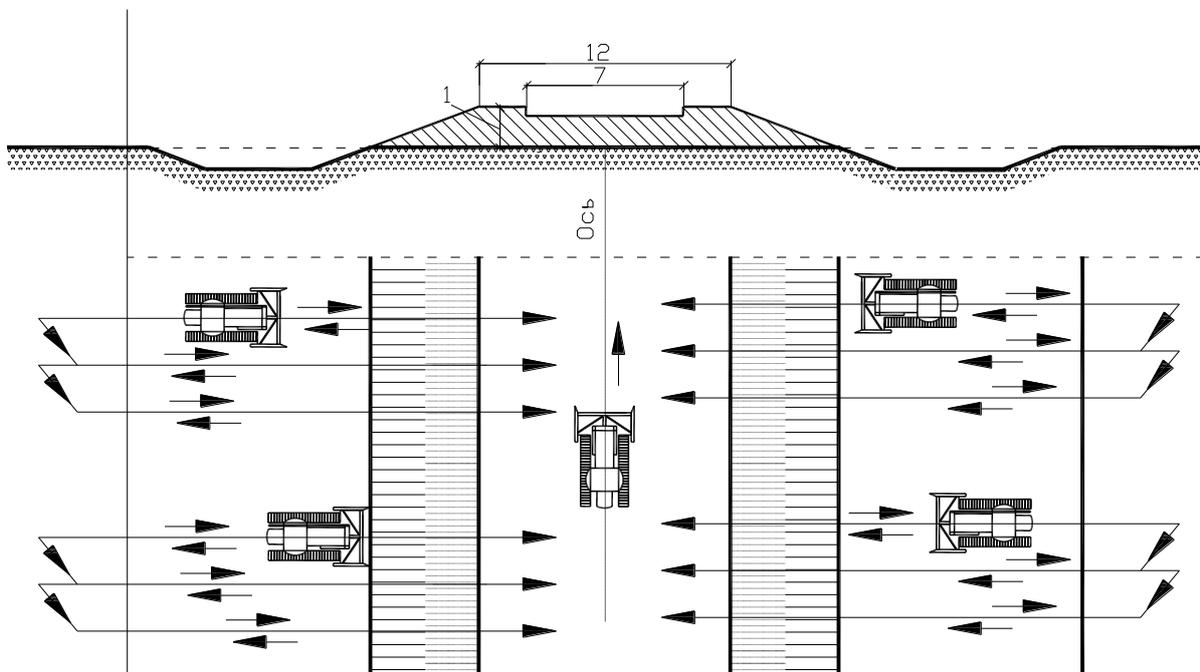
Схема возведения насыпи бульдозерами поперечными проходами из двустороннего резерва
